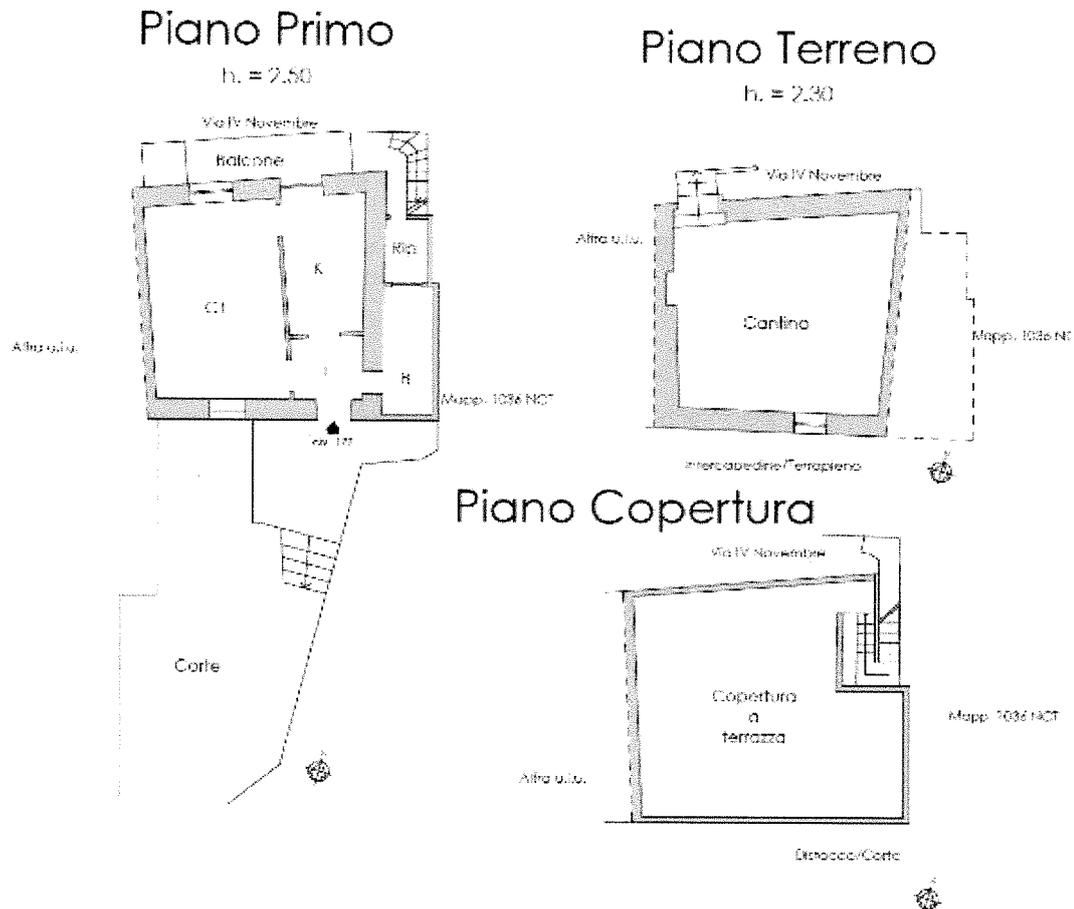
Stralcio planimetria immobile e identificazione locali appartamento oggetto di stima
